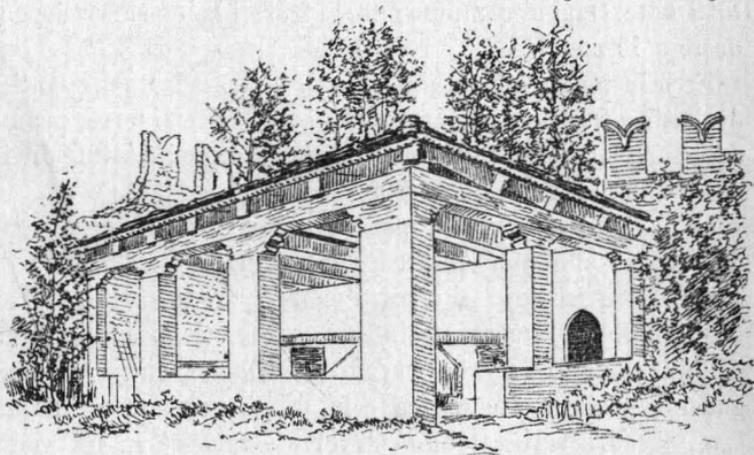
Schizzo prospettico della tettoia delle armi.
